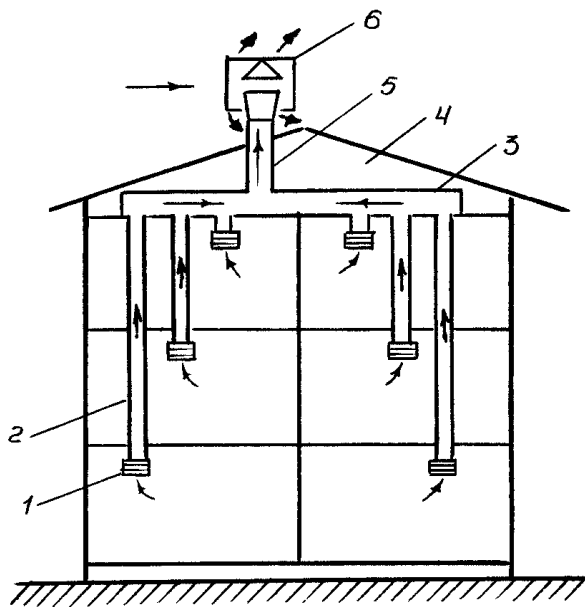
Естественная канальная вытяжная вентиляция здания.
